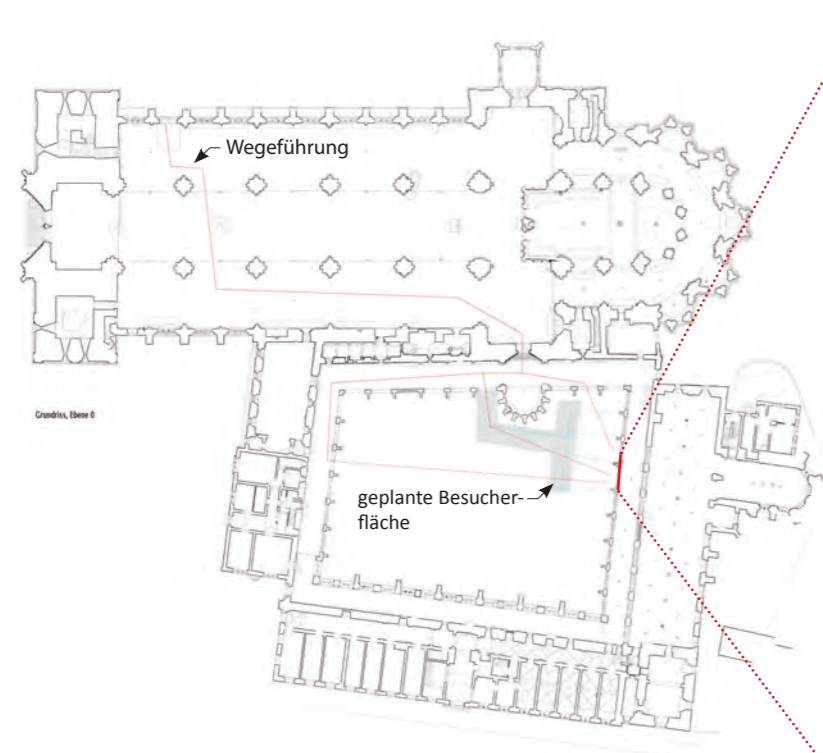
Grundriss Magdeburger Dom mit Kreuzgang und aktueller Wegeführung (rote Linie) sowie geplanter Besucherfläche (graue Fläche)
